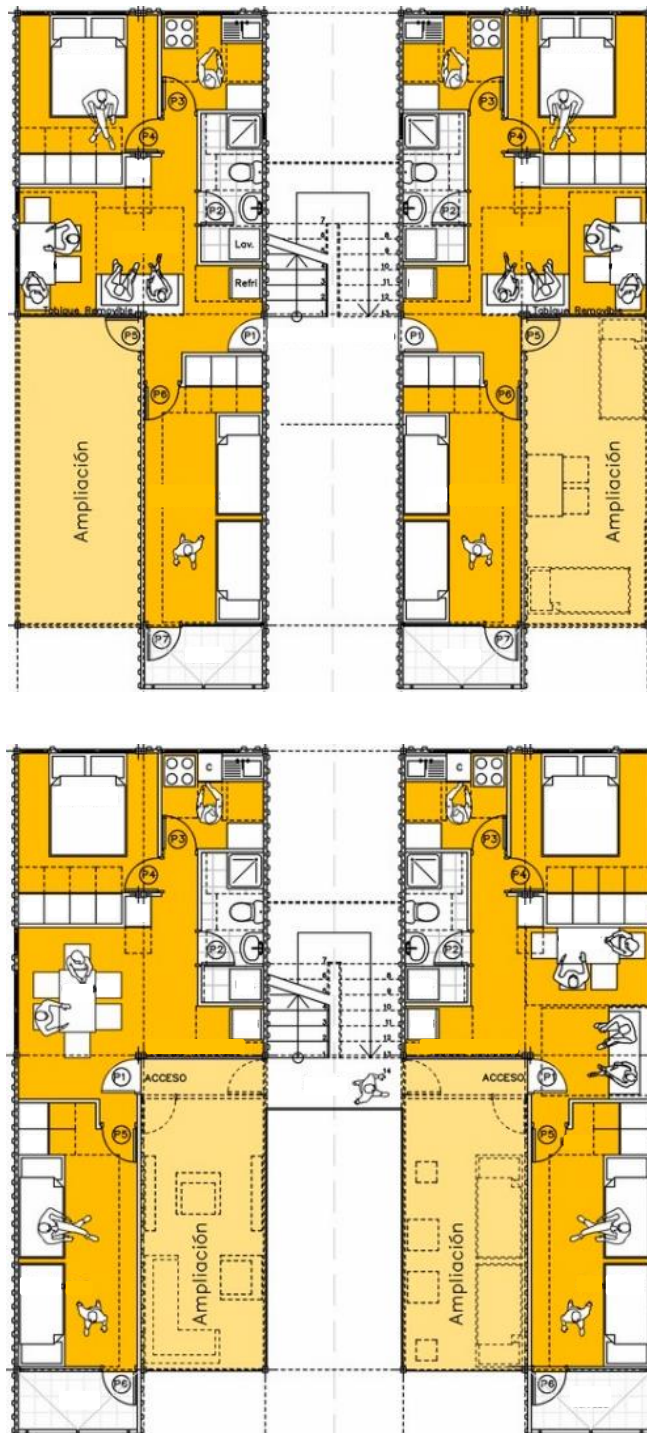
Plantas Arquitectónicas, Propuesta de vivienda social en contenedores.
